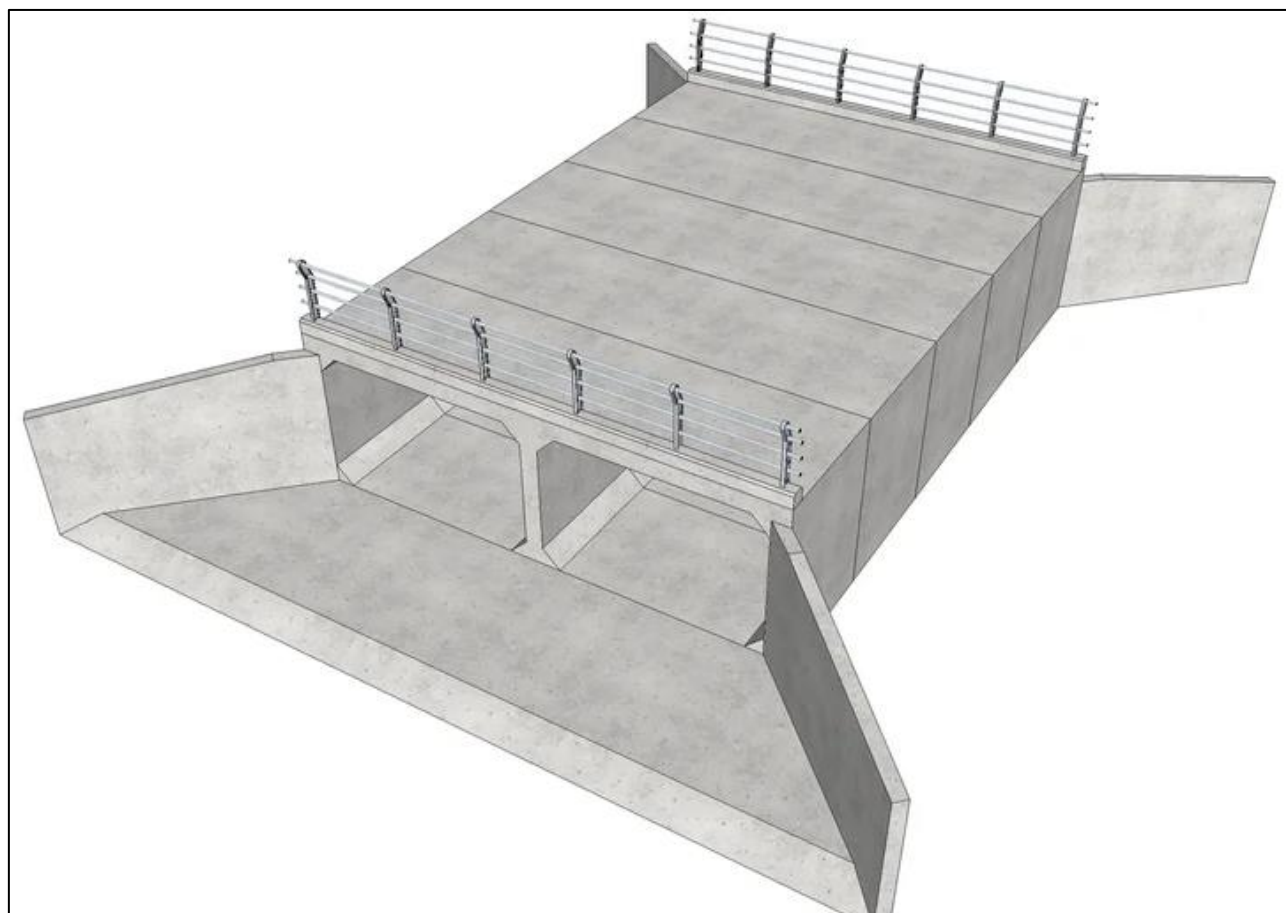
Modelo 3D Box Culvert con Sección Hidráulica Doble
